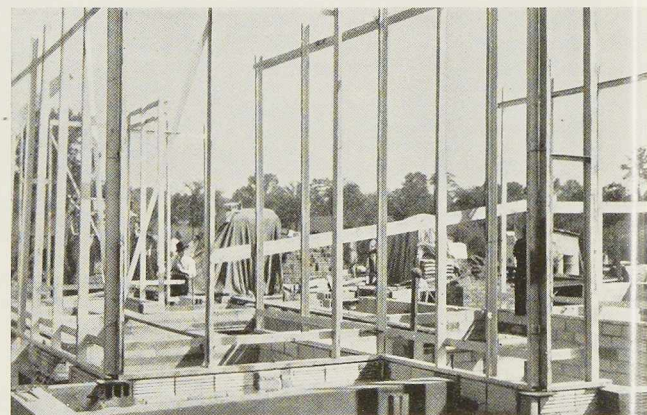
Après leur mise en place, les panneaux de murs furent assemblés provisoirement entre eux au moyen de boulons de 12,5 mm. On procéda ensuite à la pose des solives en fers U du plancher du rez-de-chaussée.
